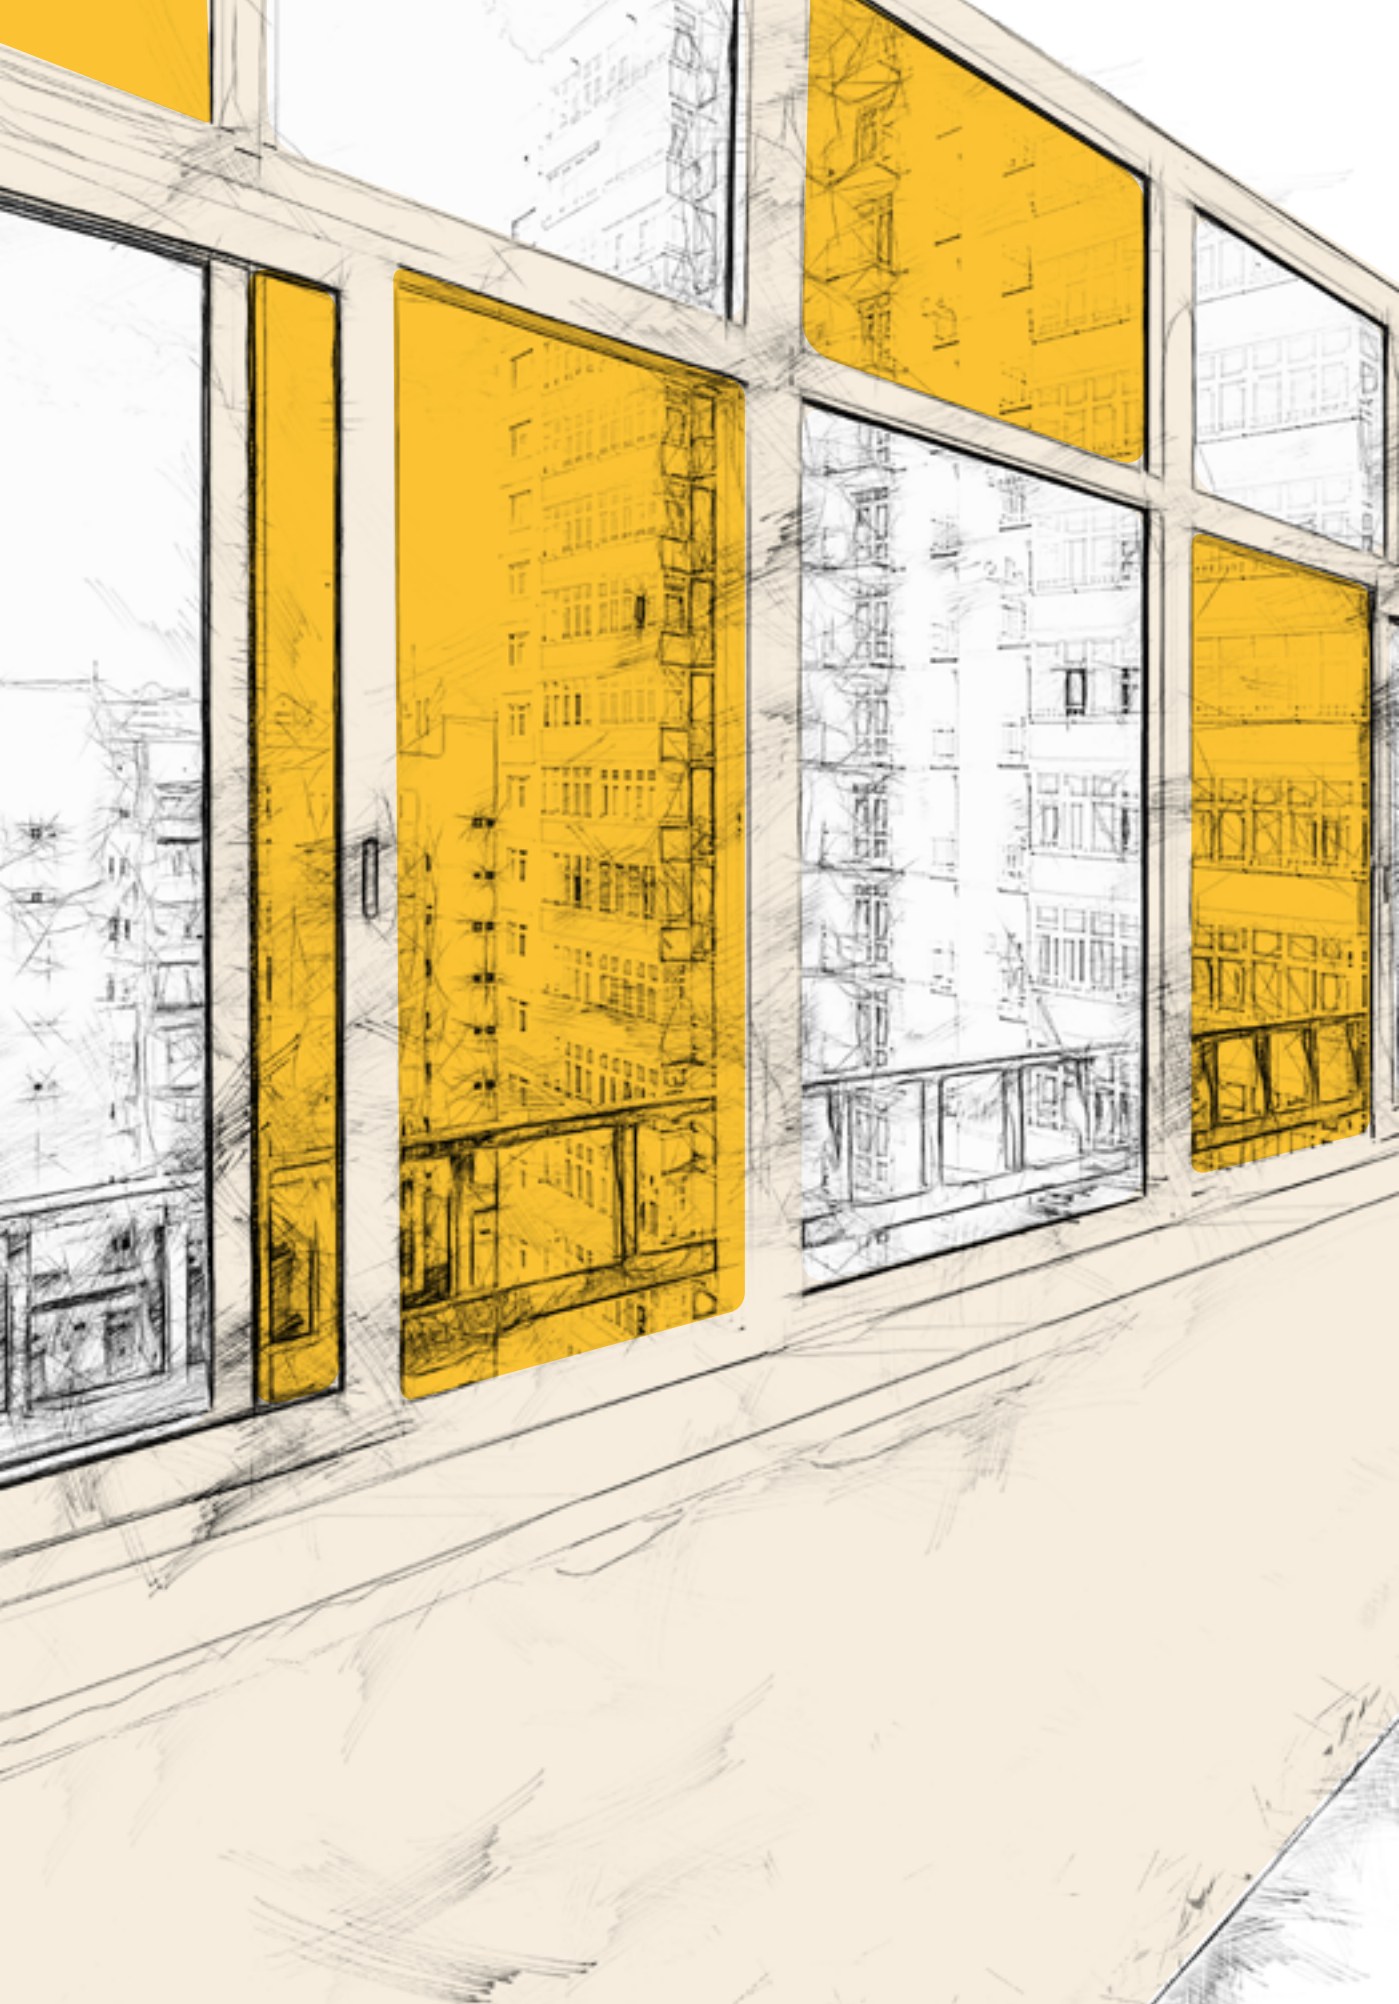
Aplicação de vidros de segurança abaixo de 1,10m, a partir do primeiro pavimento (Imagem cedida pela Abravidro)
